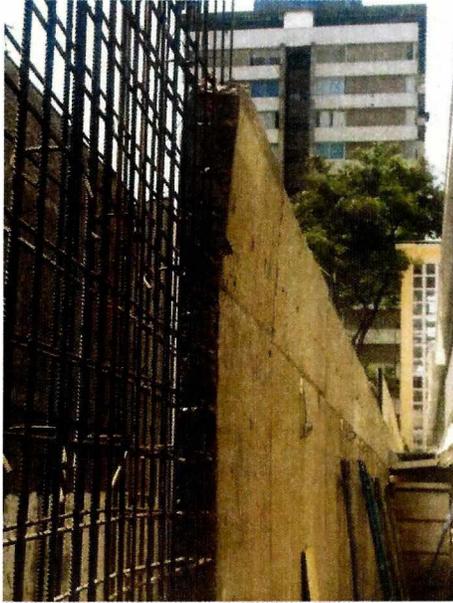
Detalle a contraluz de la falta de linealidad de la junta de hormigonado en el eje 1, entre los ejes B y E.
